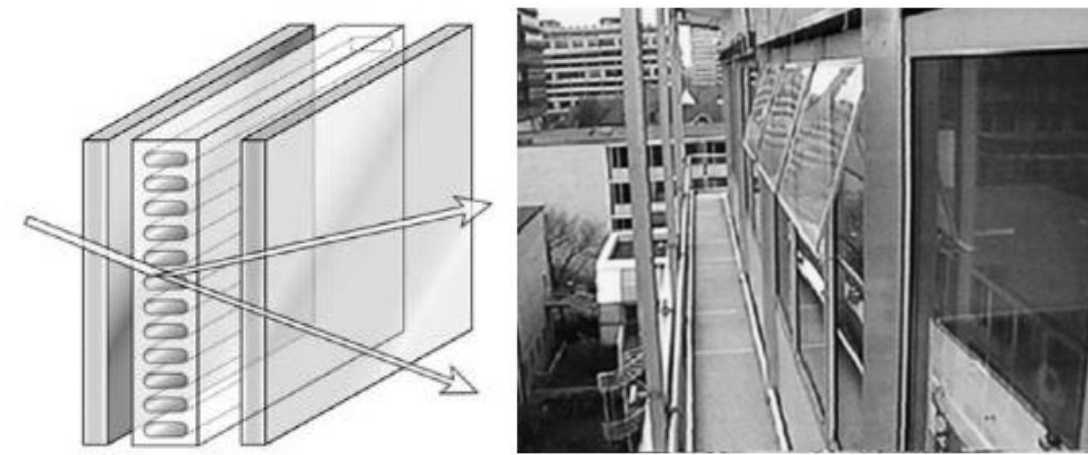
A gauche, Laser cut panels (Source: Damelin court et al., 2010) ; A droite, façade équipée d'un LCP (Source: Daylight in buildings 2000)
